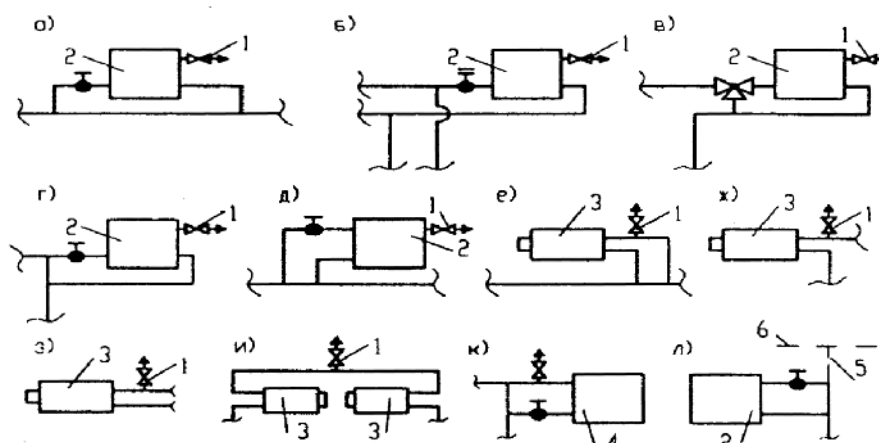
Способы удаления воздуха из систем водяного отопления с нижней разводкой: а, б, в, г, д, - через краны, установленные в верхних пробках радиаторов; е, ж, з, и через краны, установленные на подводках к стальным панелям; л - через воздушные трубы: 1-воздушный кран, 2-отопительный прибор (радиатор), 3 - то же, конвектор, 4-то же, стальная панель, 5 - воздушный стояк; 6-воздушная магистраль.
